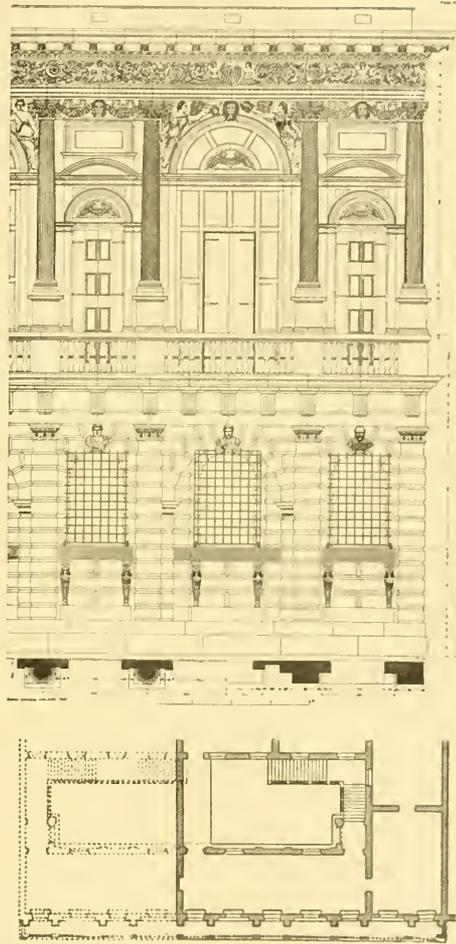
u. 263. Verona, Palazzo Bevilacqua. Fassaden-system und Grundriß.
